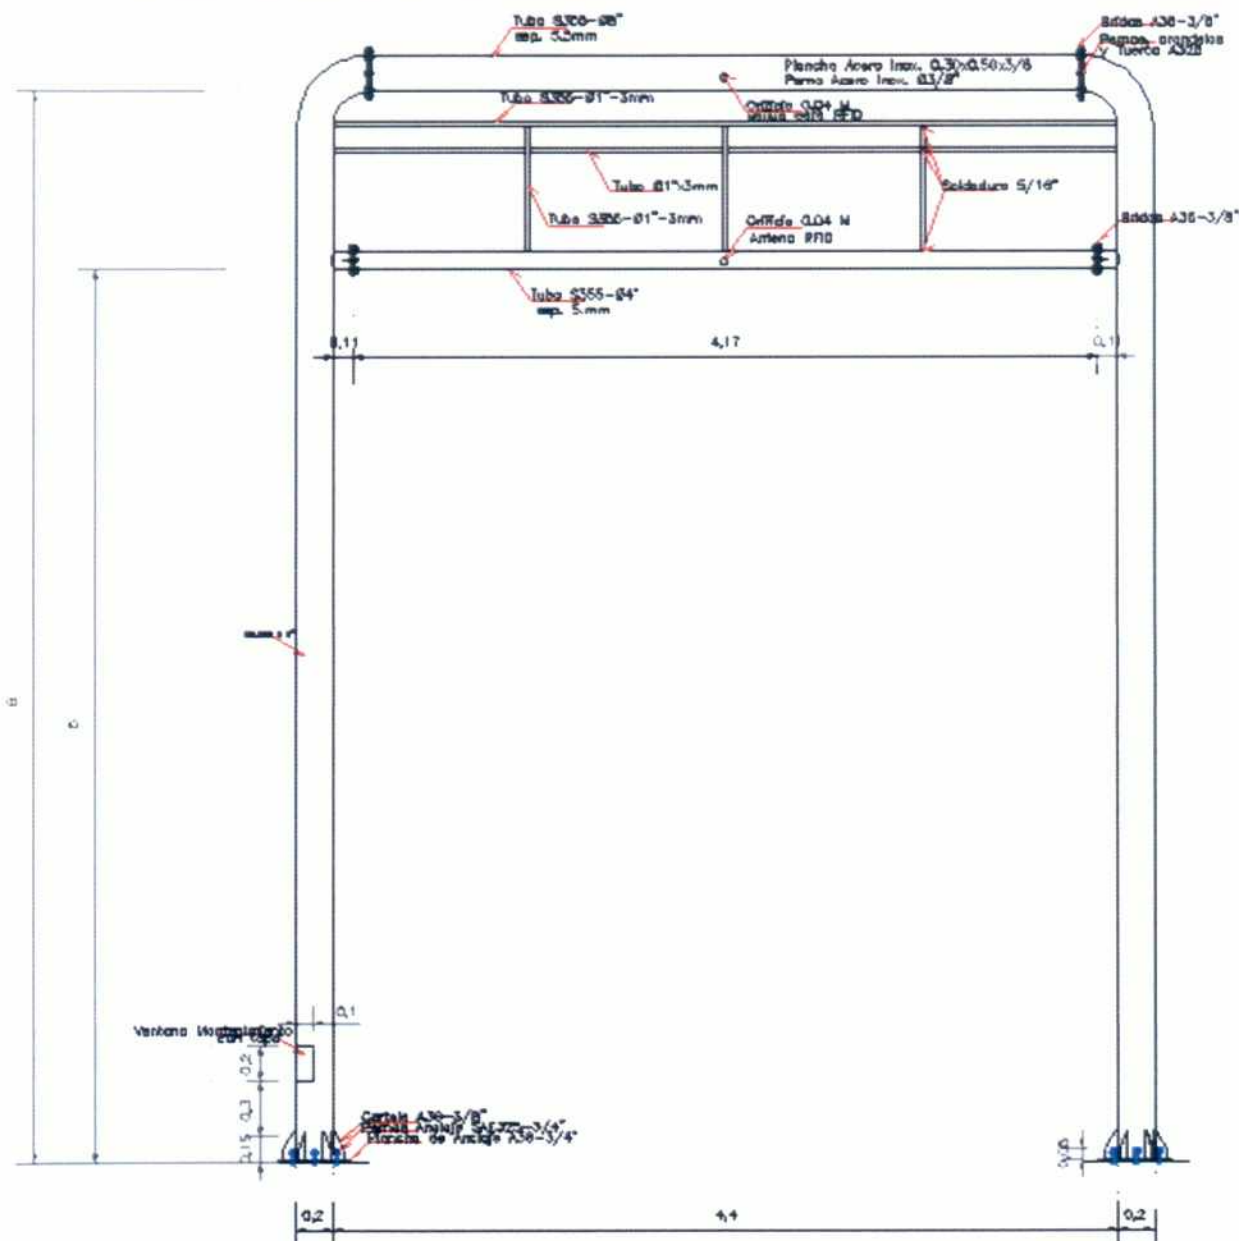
Plancha de Anclaje de las columnas cartelas y pernos de anclaje del Pórtico para RFID
